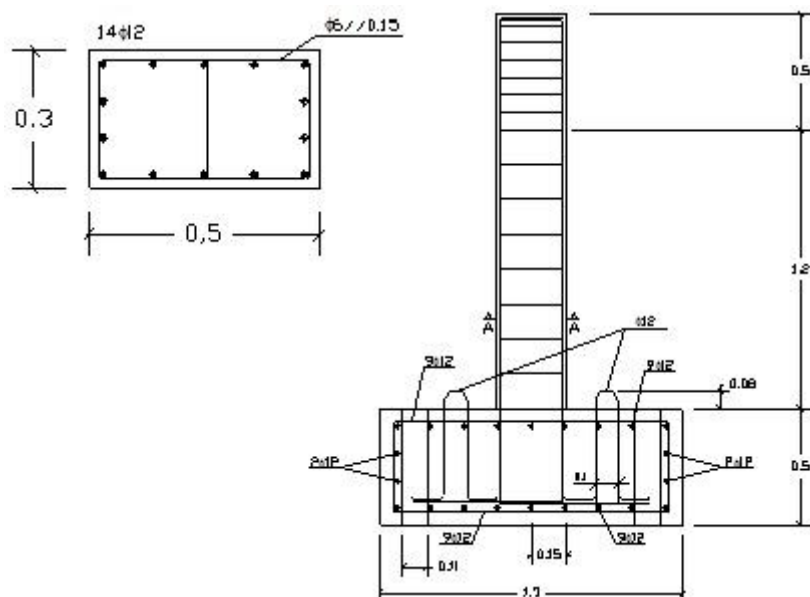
Geometria e armadura dos pilares (LESE, 2014).
